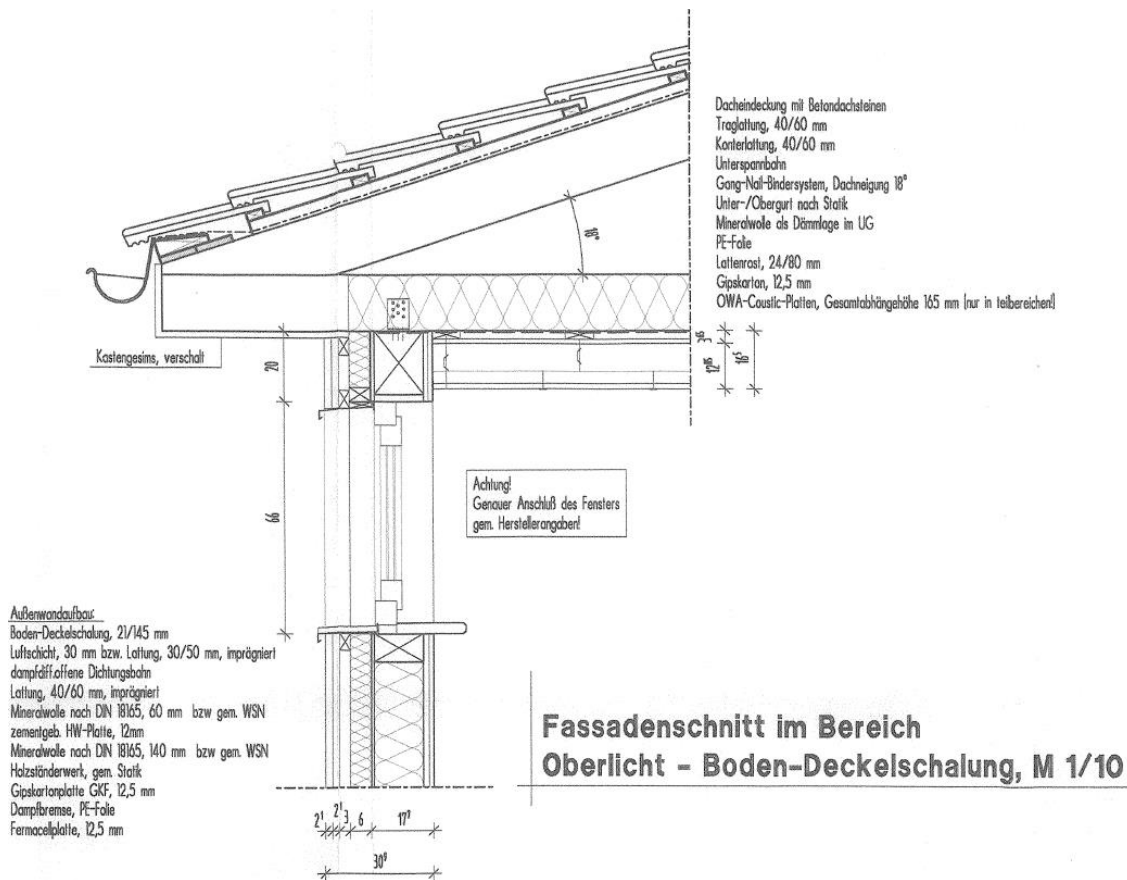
Fassadenschnitt mit Wand- und Deckenaufbau
